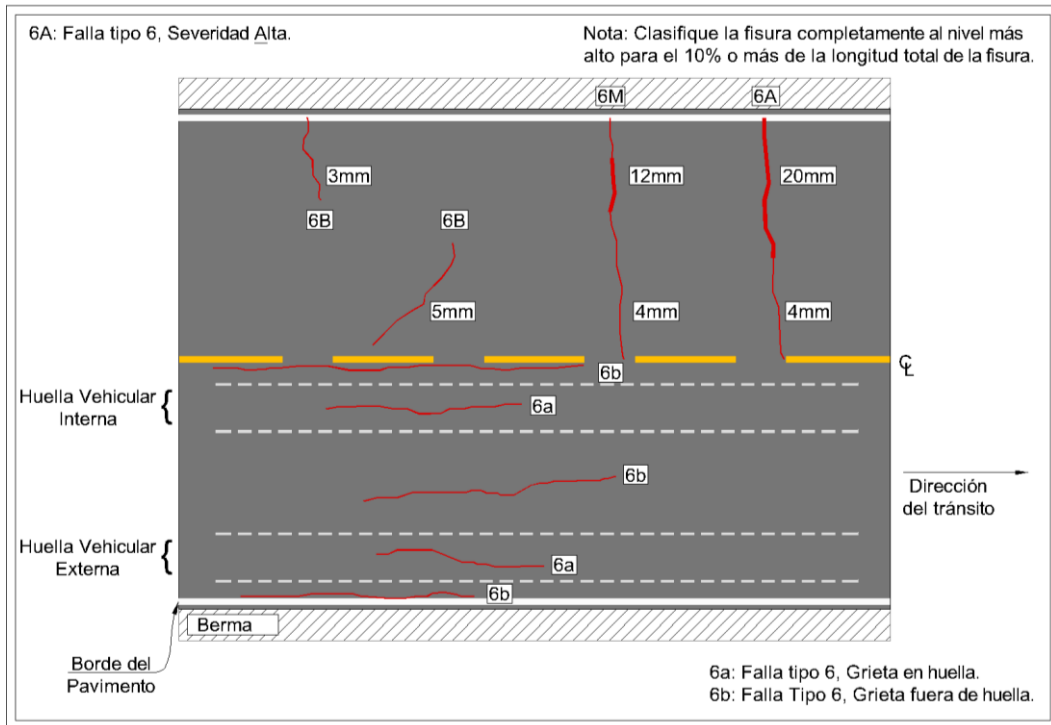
Grietas Longitudinales y Transversales.
